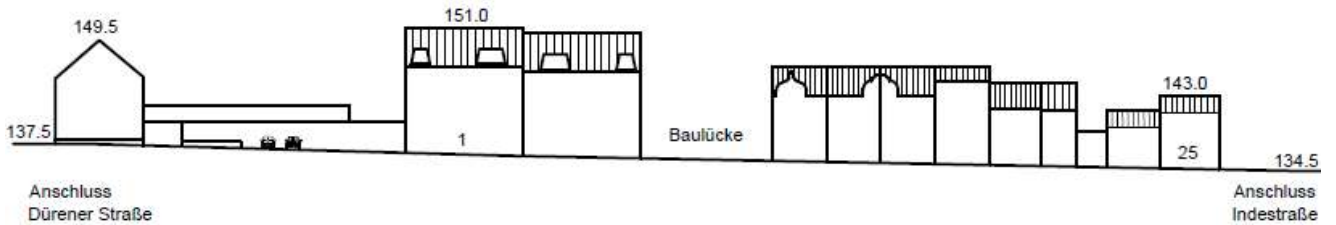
Schematische Fassadenabwicklung Peilsgasse, Höhenangaben näherungsweise in m ü NNH [Quelle: Stadt Eschweiler]
